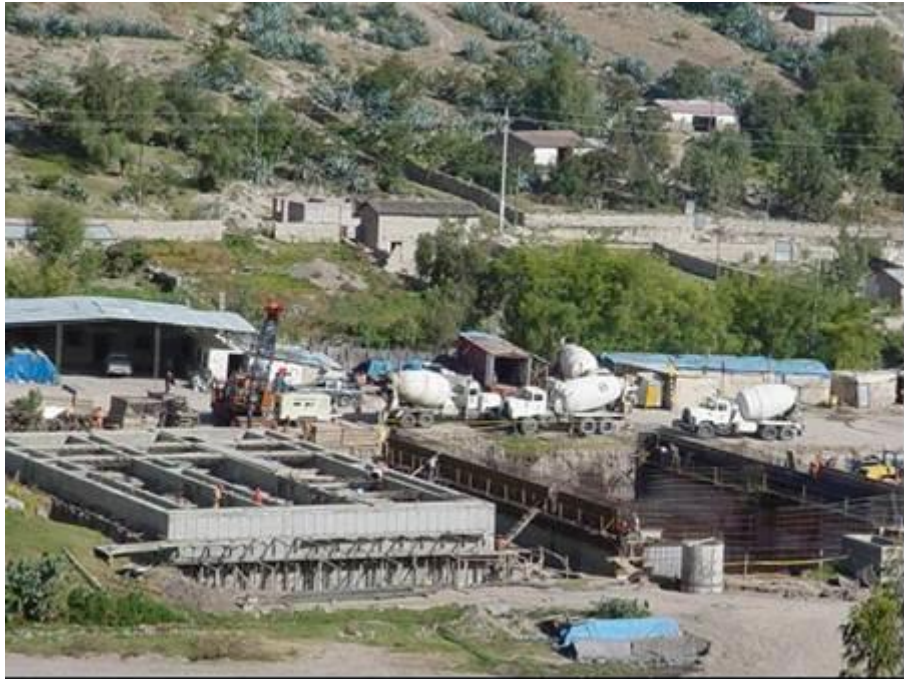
Vista constructiva de los Tanques Imhoff 05 y 06
